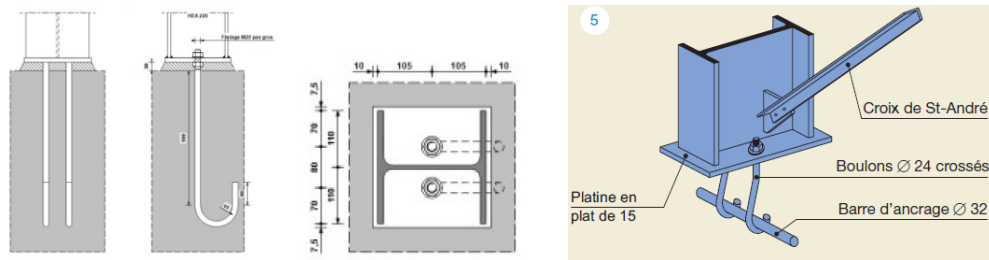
pieds de poteaux articulés à deux tiges d’ancrages avec crochet autour d’une barre de fixation
